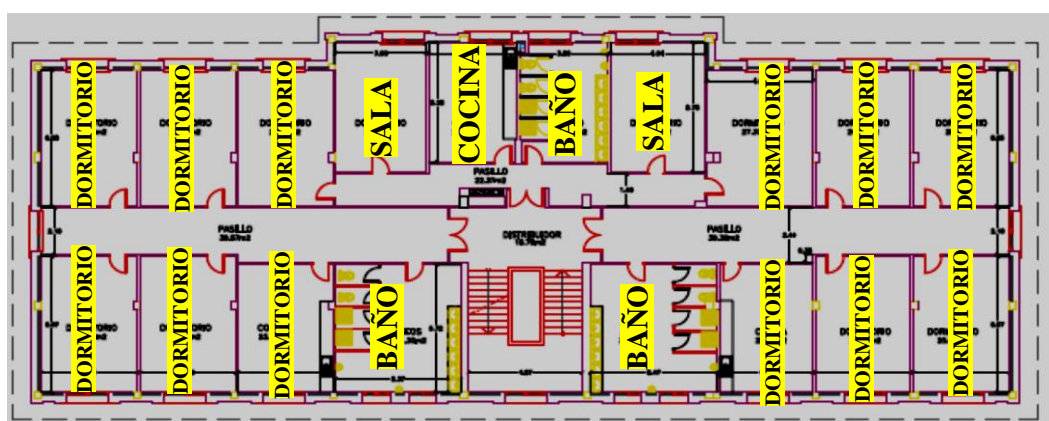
Plano alojamientos. Fuente: Elaboración propia (plano del plan de mantenimiento 2019)
